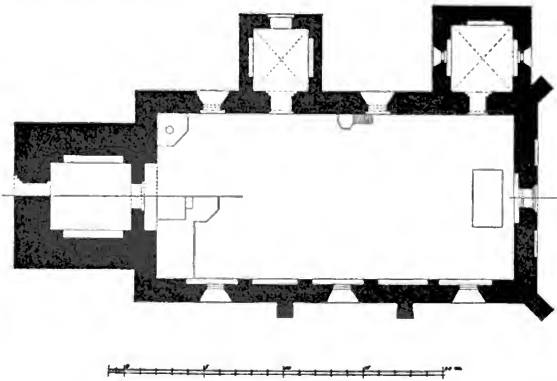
Grundriß der Pfarrkirche zu Roggenhausen.
